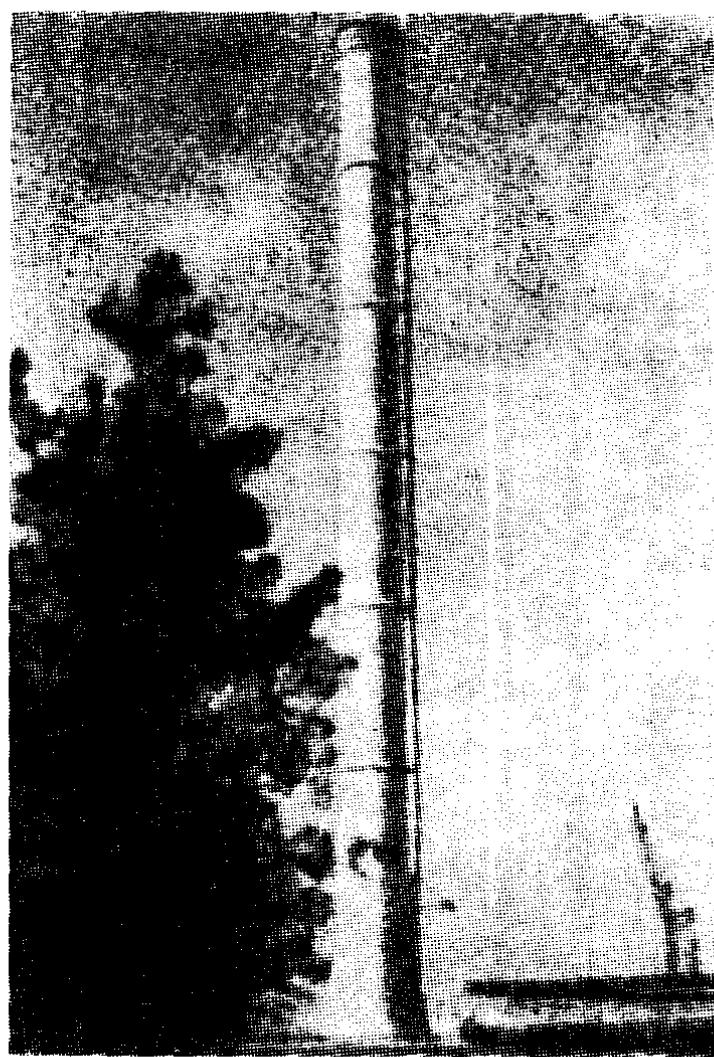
东德正在施工中的火力发电厂300米高的整体式钢筋混凝土烟囱
